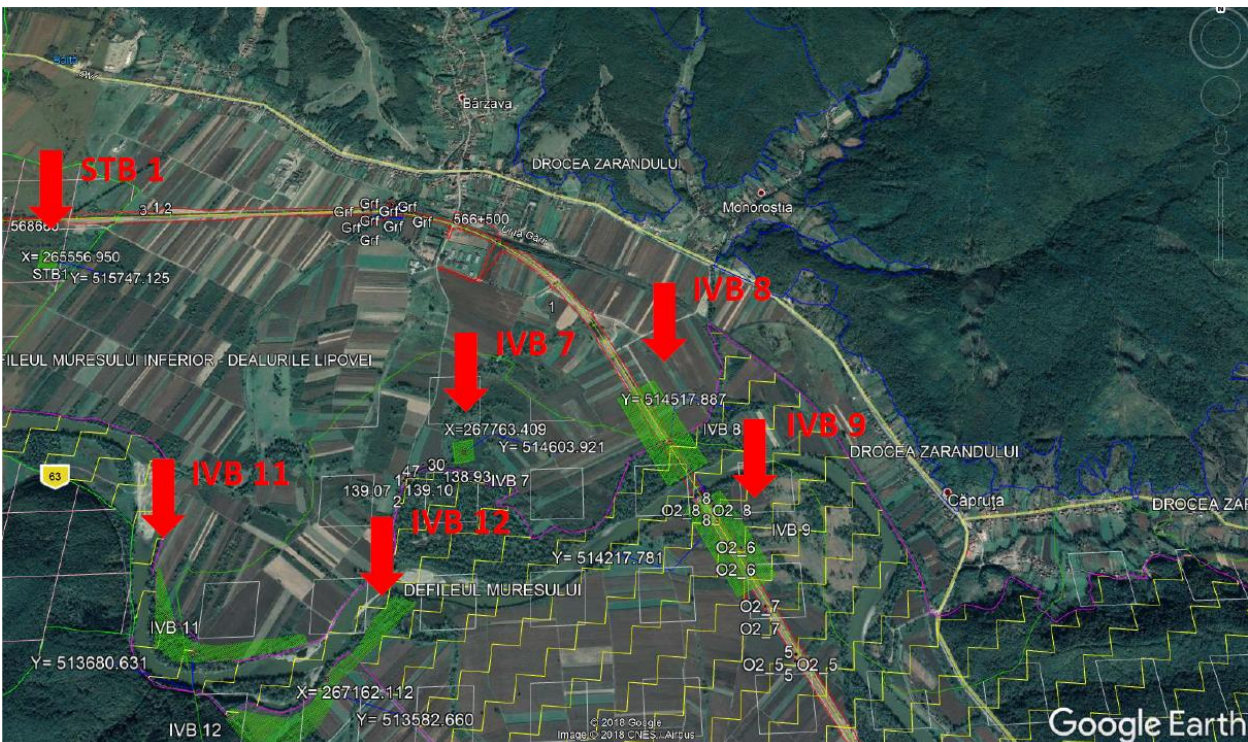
Plan de amplasament pentru platformele STB 1, IVB 7, IVB 8, IVB 9, IVB 11, IVB 12 – vedere din satelit
